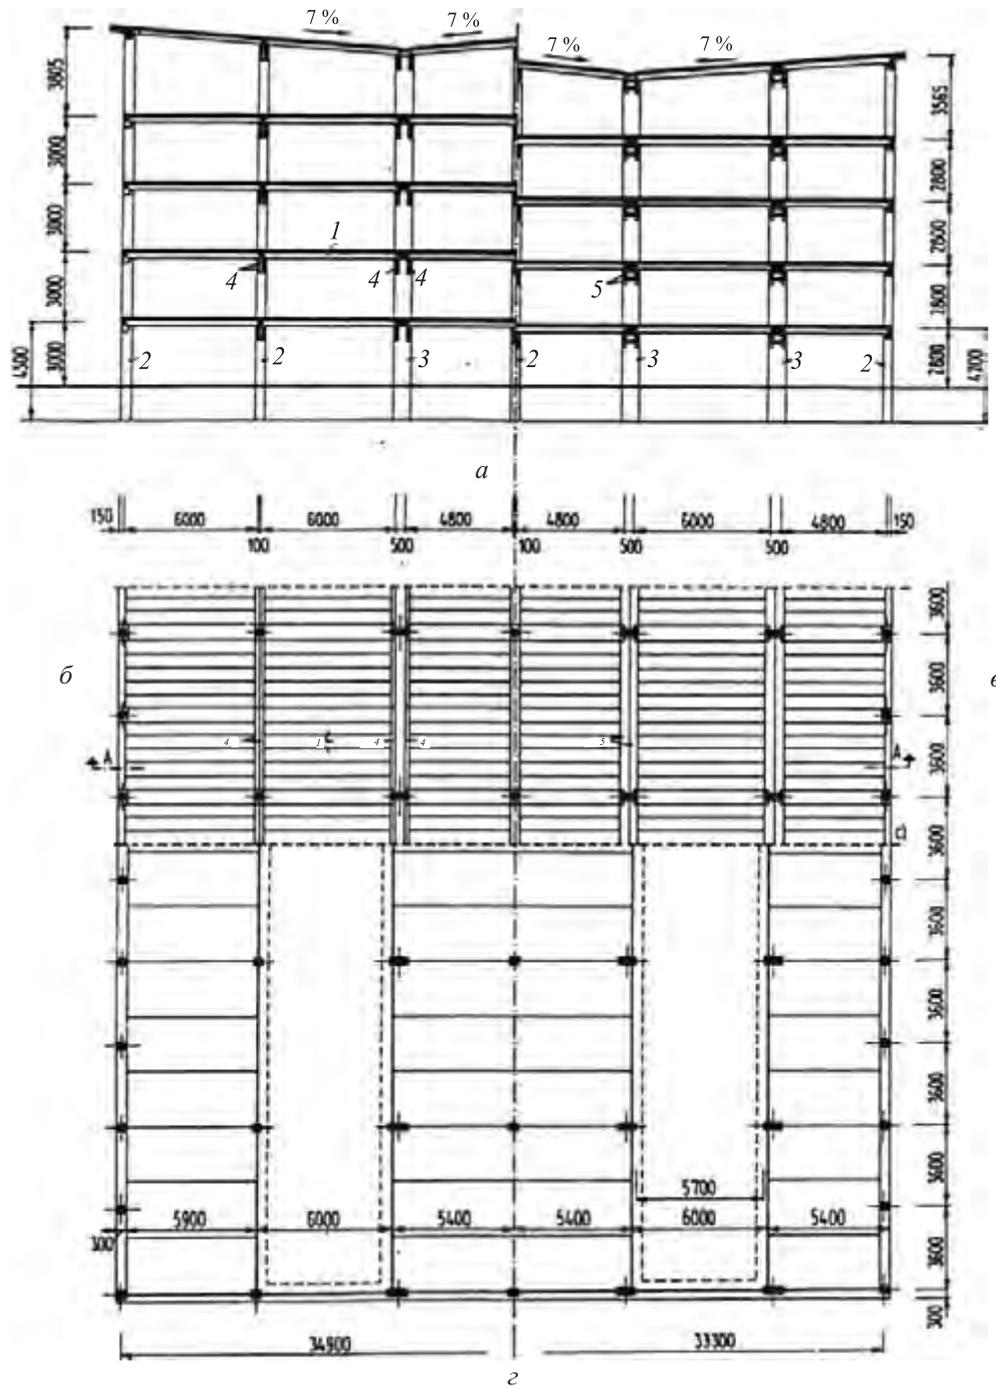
Прямоугольная расстановка автомобилей при поперечном шаге колонн $2 \times 6000 / 2 \times 4800 / 2 \times 6000$ мм; в продольном шаге колонн 7200 мм. Высота этажа 2 800 мм: *a* — разрез; *б* — план раскладки плит перекрытия и балок (1 вариант); *в* — план раскладки плит перекрытия и балок (2 вариант); *г* — план; 1 — плиты перекрытия, 240 мм; 2 — колонны по периметру 300×400 мм; 3 — колонны промежуточные 300×800 мм; 4 — ригели 150×650 мм; 5 — ригели U-формы, 400×450 мм
